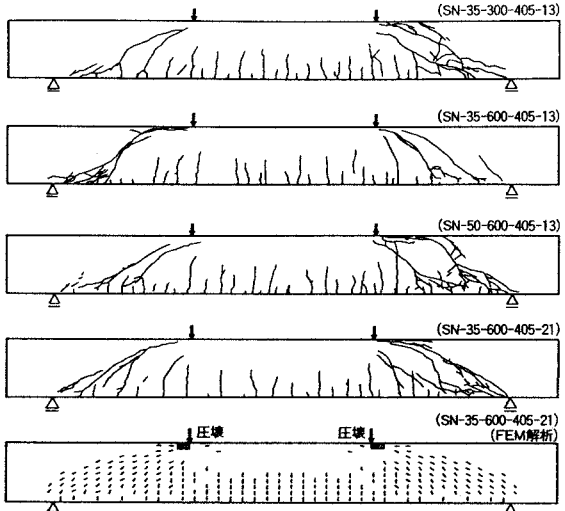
最終ひび割れ状況（せん断破壊試験）
